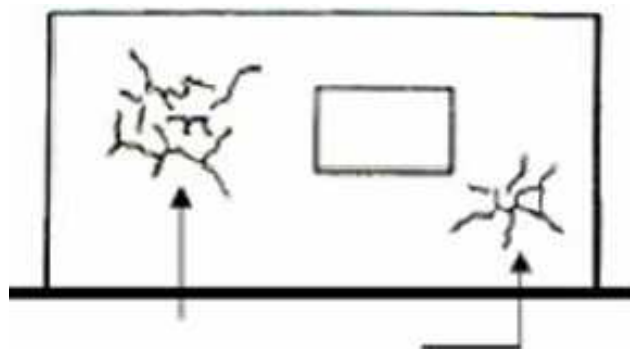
Fissuras na argamassa de revestimento
